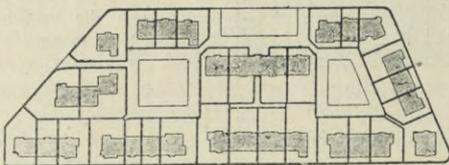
Halboffene Bauweise. Teil des Riedliquartiers in Zürich. 1:4000. Gebäude mit Maximalängen und bestimmten Abständen
